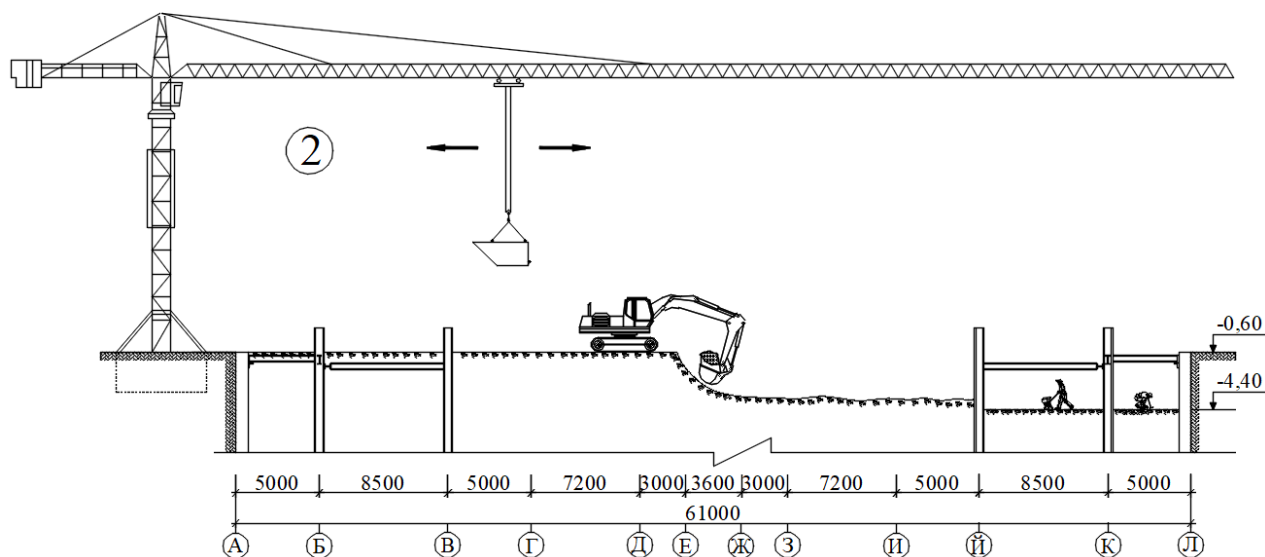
Откопка грунта от отметке -0,6м до отметке -4,4
